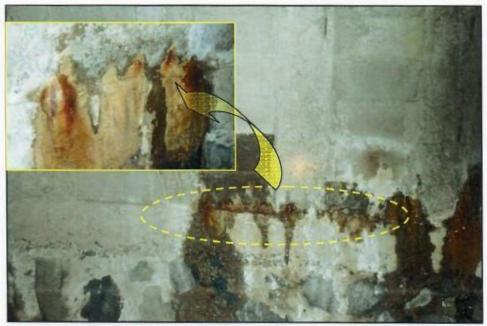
Infiltraciones y acero de refuerzo expuesto y corroído (0+070 - 0+090).
